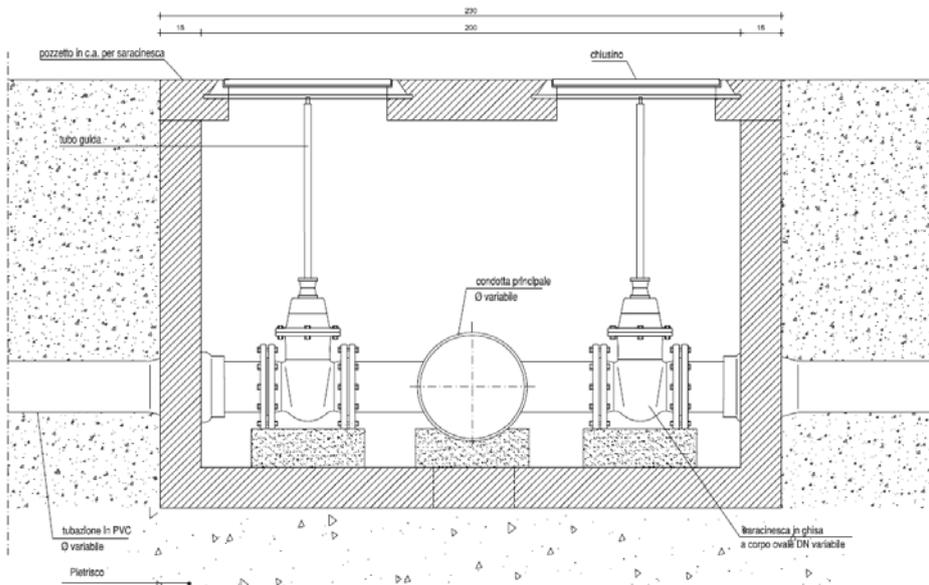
Sezione tipo pozzetto alloggiamento saracinesche
